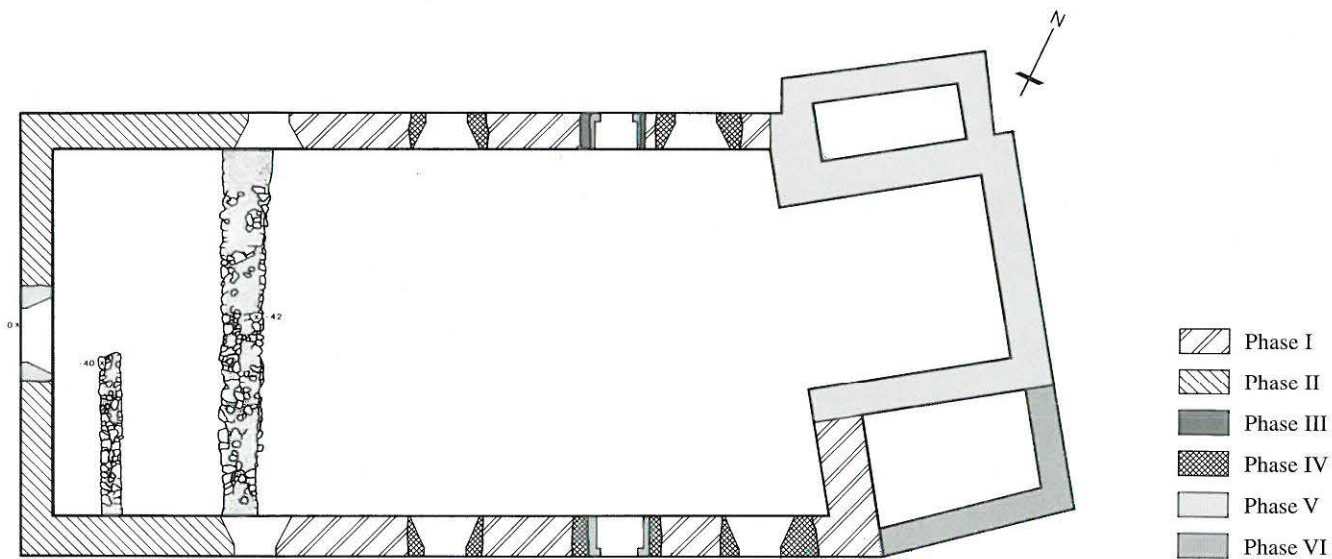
Boltigen, Kirche. Grundriss mit Bauphasen. M. 1:200.
